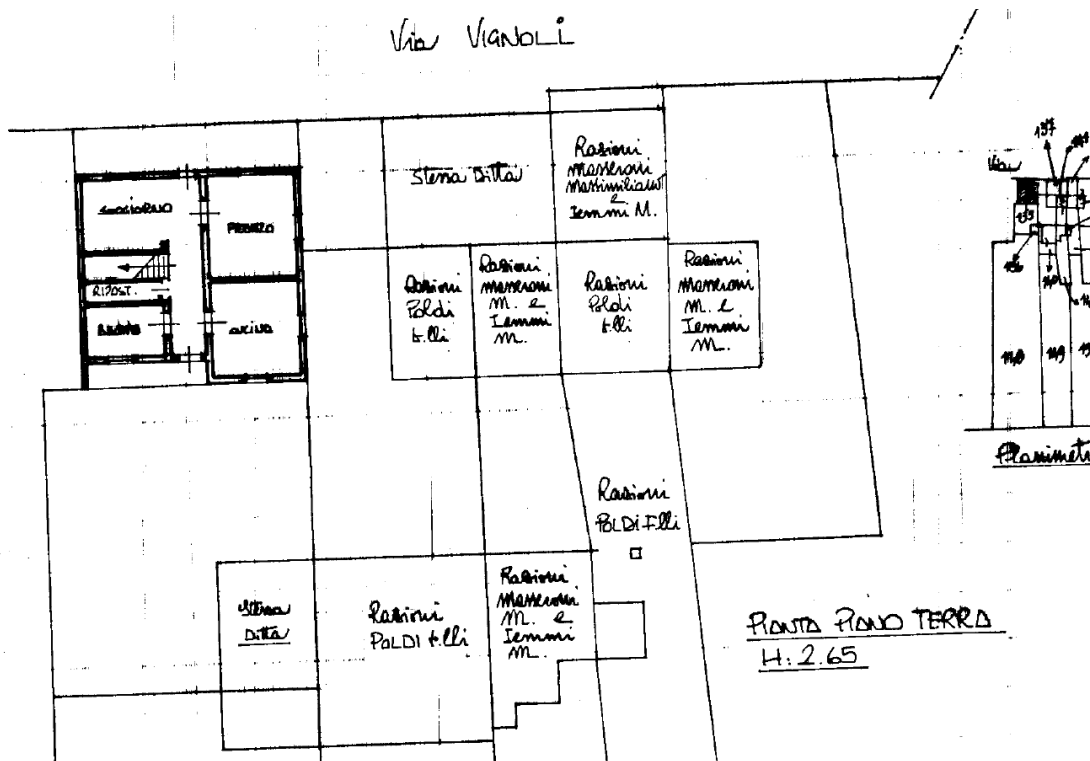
Pianta piano terra - inquadramento da planimetria - fuori scala
